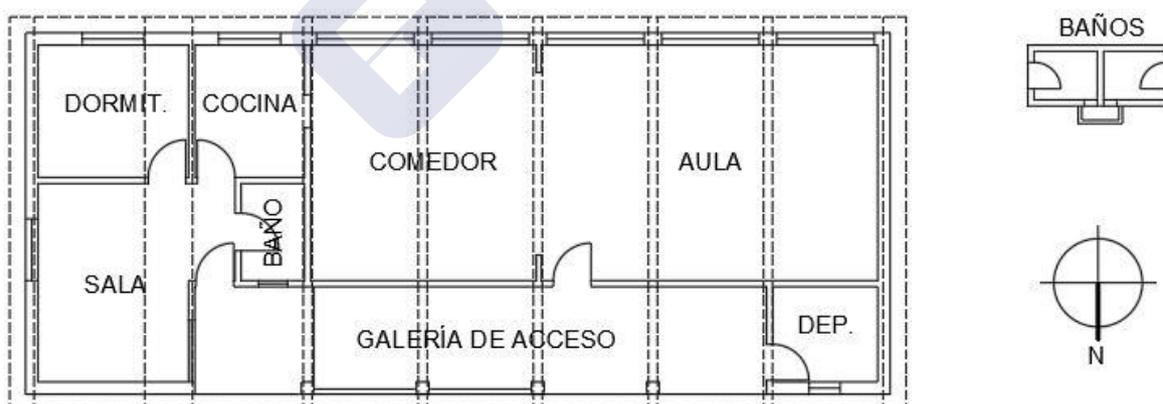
Planta esquemática Escuela rural 36 Sauce Chico.
